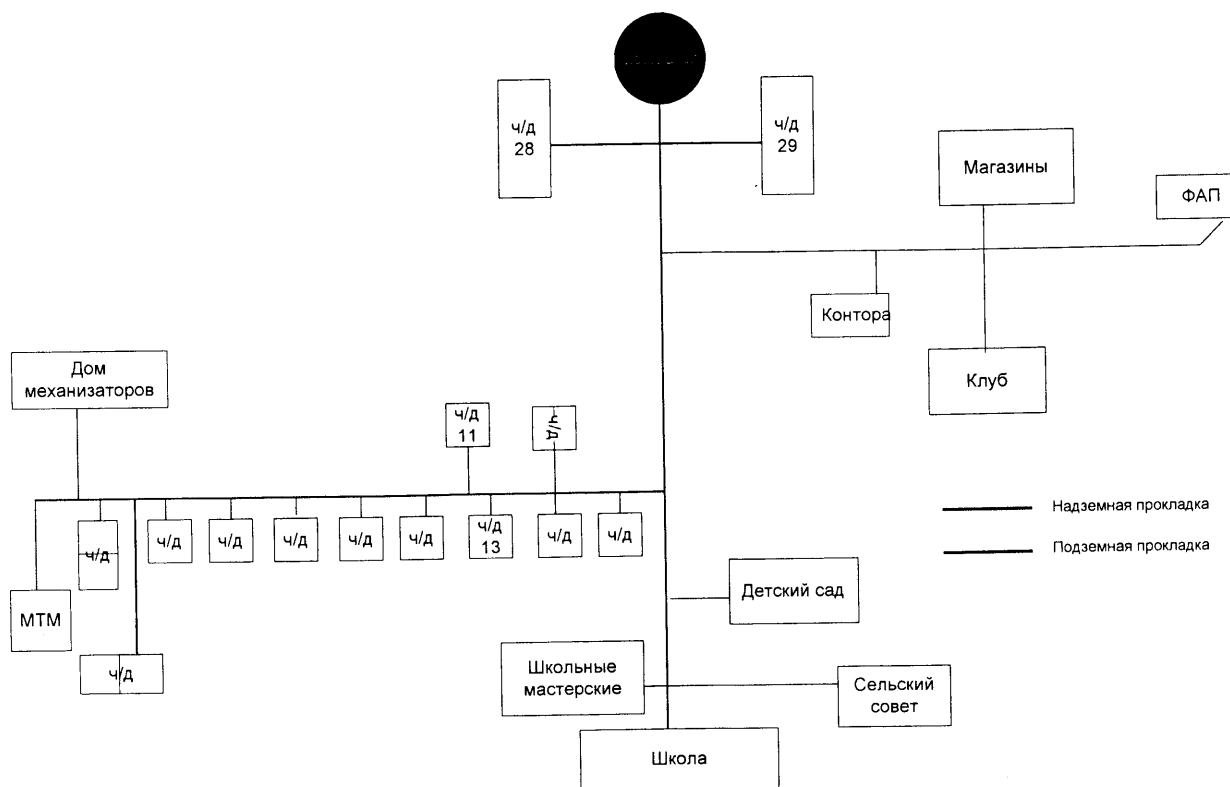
Схема размещения тепловых сетей от котельной с.Брылино
